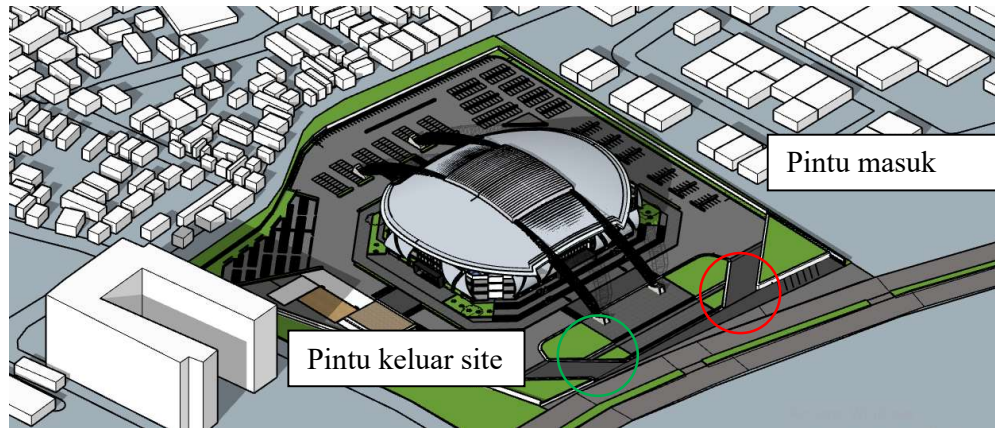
Gambaran tampilan bangunan *Hi-Tech building
